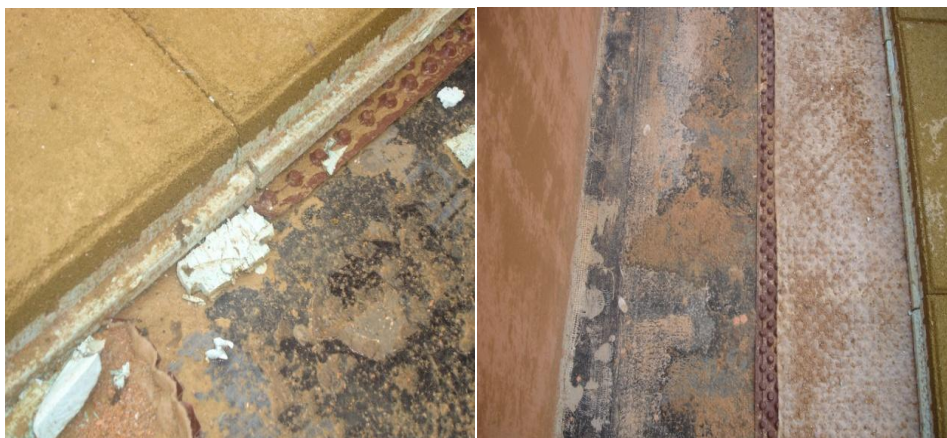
Pormenores construtivos do terraço, Guarda
